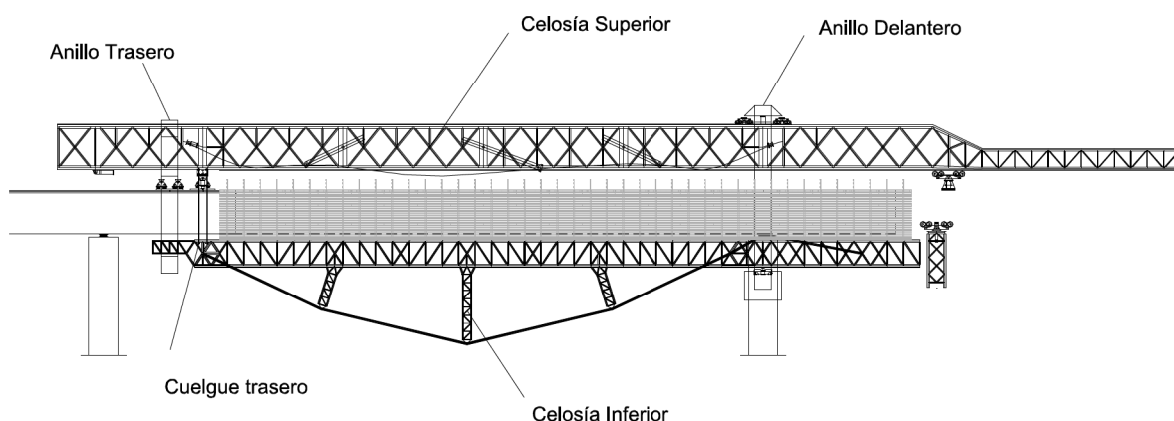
Alzado de autocimbra híbrida con OPS para construcción de vanos con 80 m de luz
